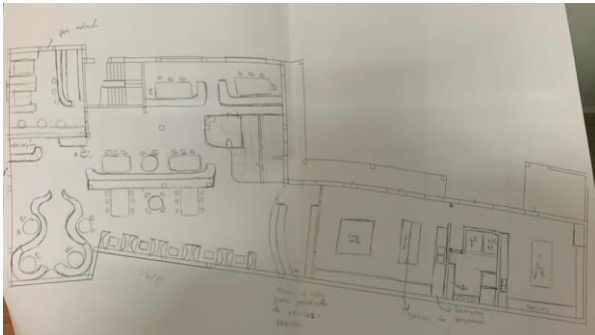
3ª Proposta mais elaborada; Fonte: autor
